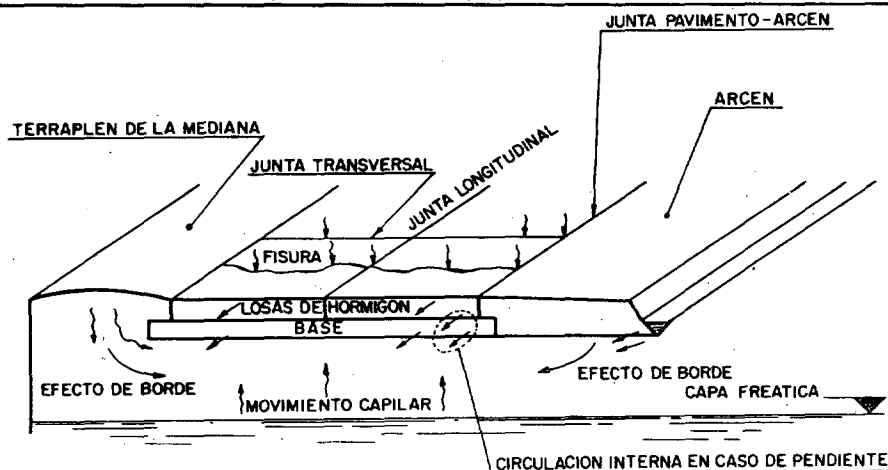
Vías de aportación de aguas en un pavimento de hormigón.
